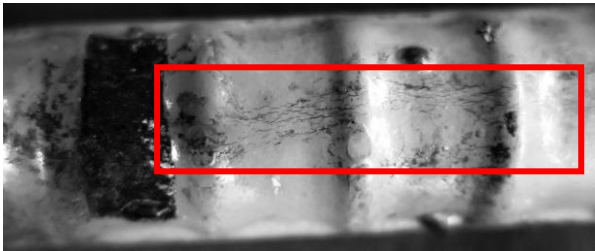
損傷部から発生した EP 樹脂塗装の微細なひび割れ (枠部)
